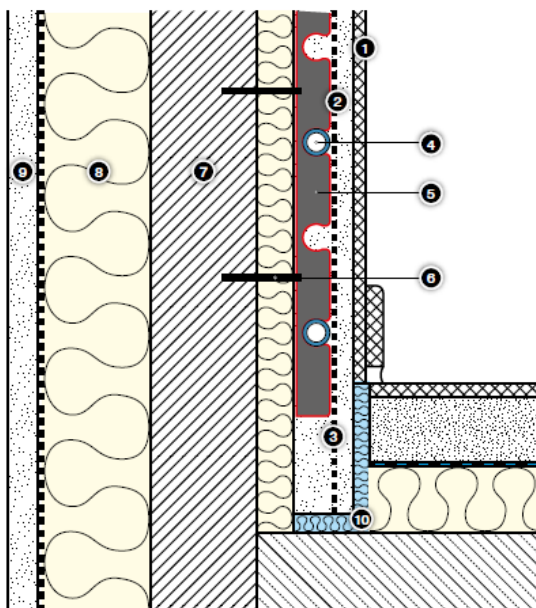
Конструкция стенового отопления Kan-thermRailWall:
